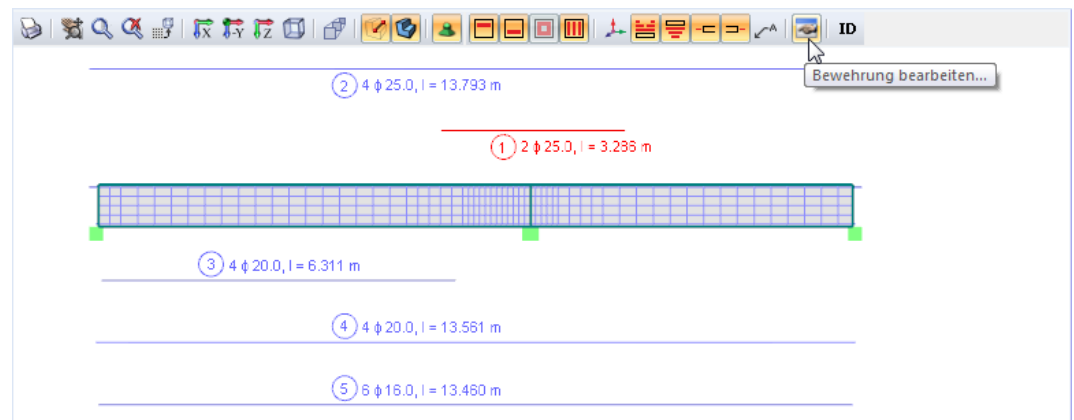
Bewehrungsskizze in Maske 3.1 Vorhandene Bewehrung
